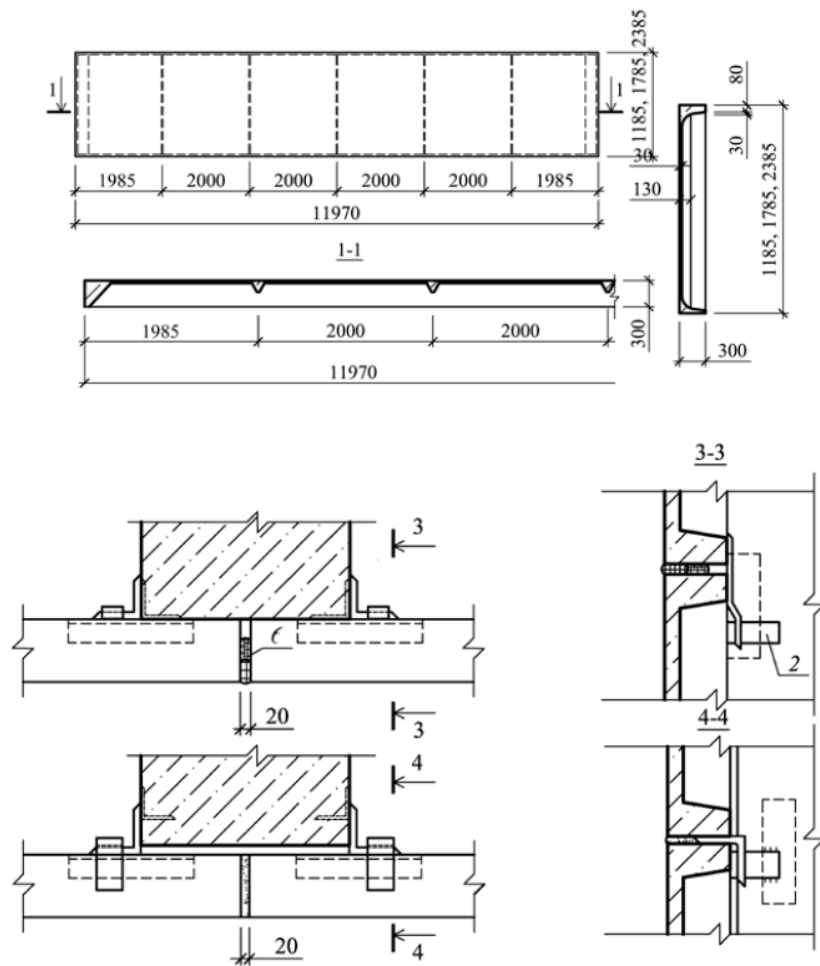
Залізобетонна ребриста стінова панель та деталі її кріплення
